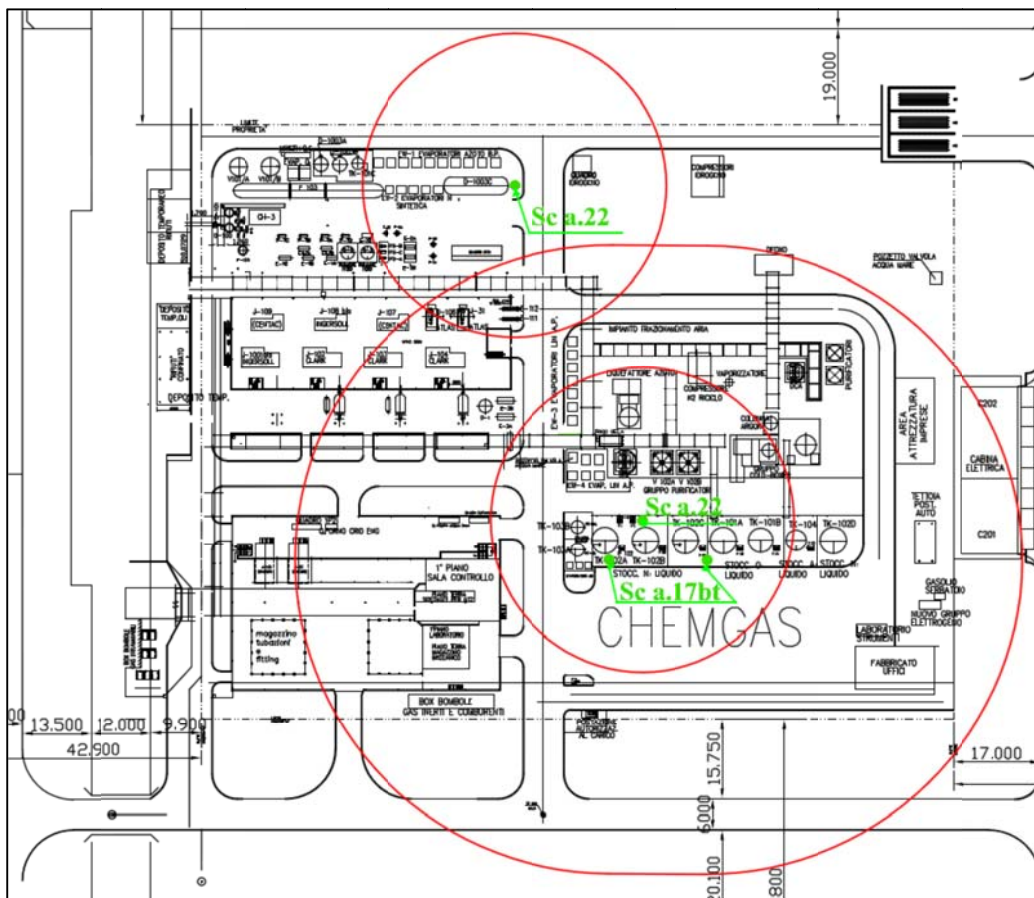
Stralcio della Planimetria limiti proprietà impianto – Dispersione Azoto Rottura Totale F2
